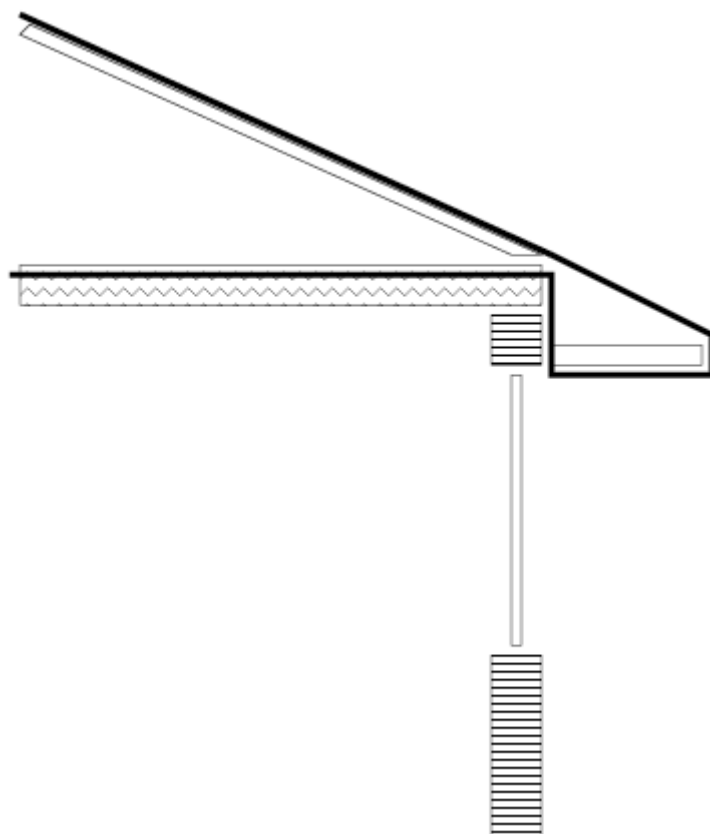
Variante con estensione dell'aggetto del tetto.
